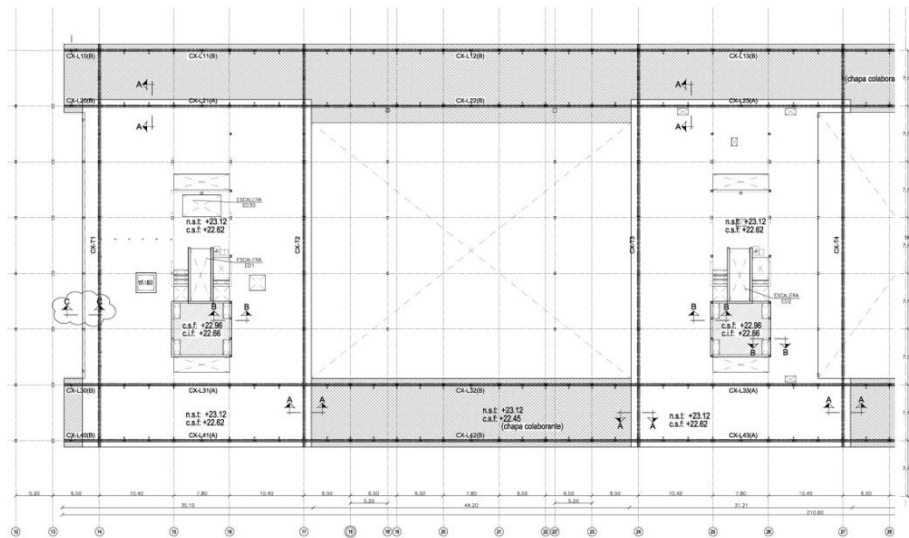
Nivel de planta cubierta (quinta). Mitad oeste.
